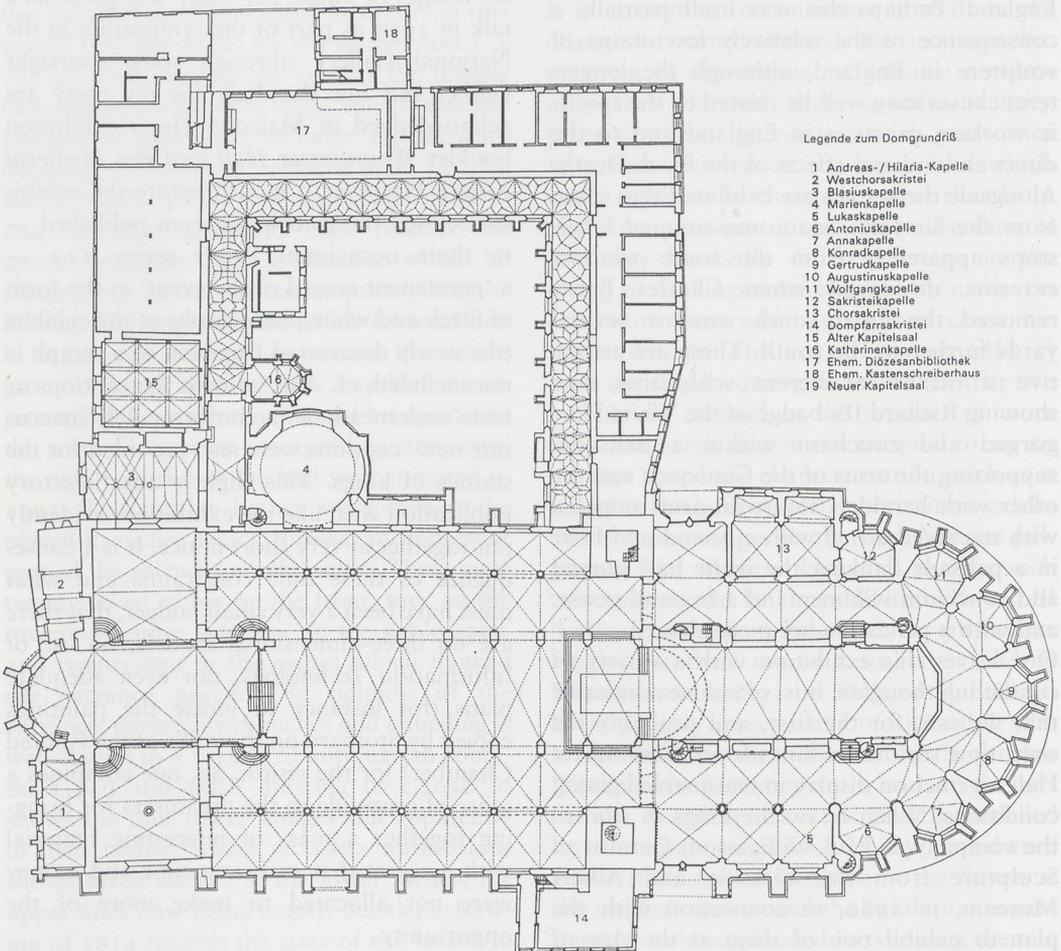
Augsburg, Dom mit Annexbauten. Grundriß nach Chevalley, Taf. I
